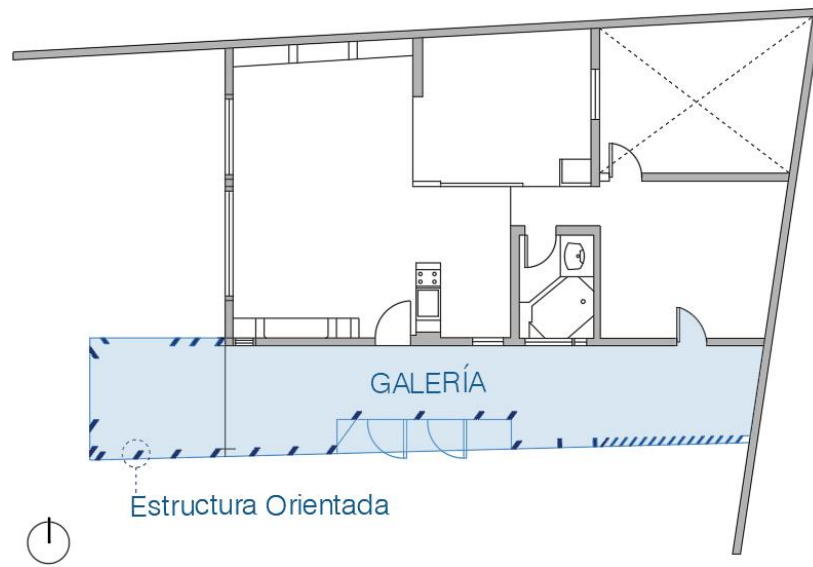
Planta Galería solar casa Kapstein. Fuente: Elaboración propia en base a revista AoA N°9, 2008.
